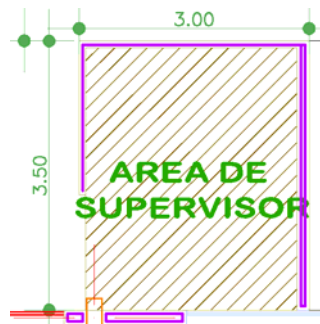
Vista arquitectónica específica del área de supervisión de la planta de reciclaje
